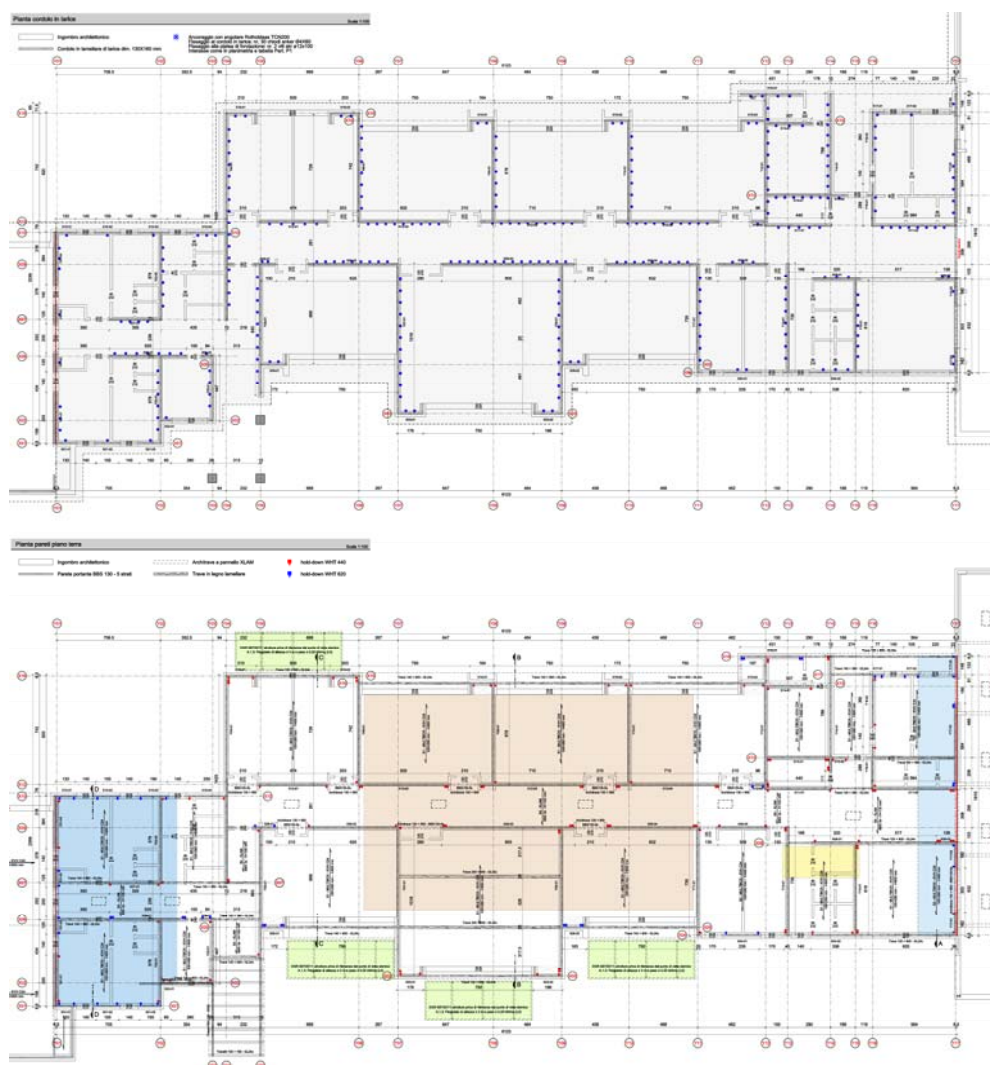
esecutivo strutture di fondazione, in elevazione e solaio di copertura
